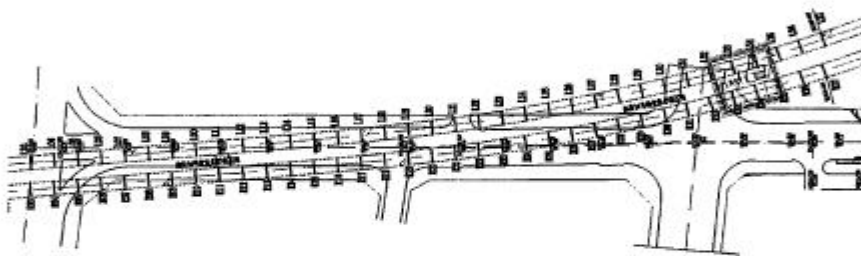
沙湖路市政工程与地铁线路位置关系平面图
